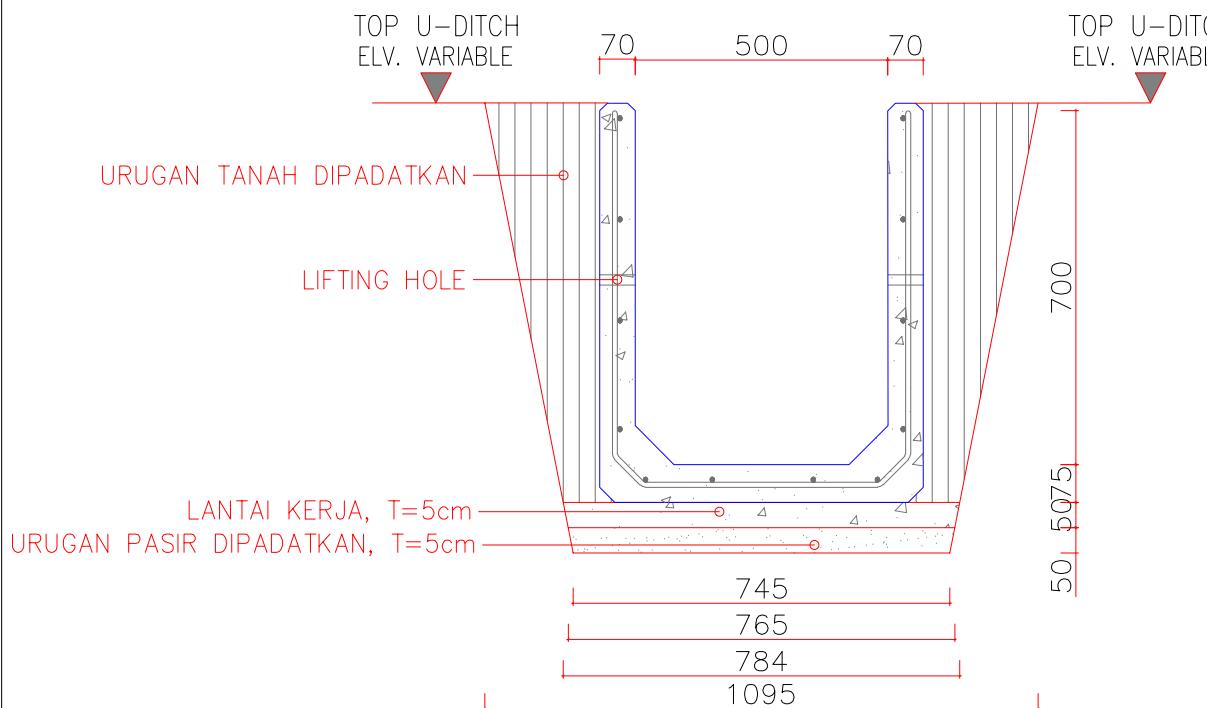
DETAIL TIPIKAL PENAMPANG U-DITCH 80x80
